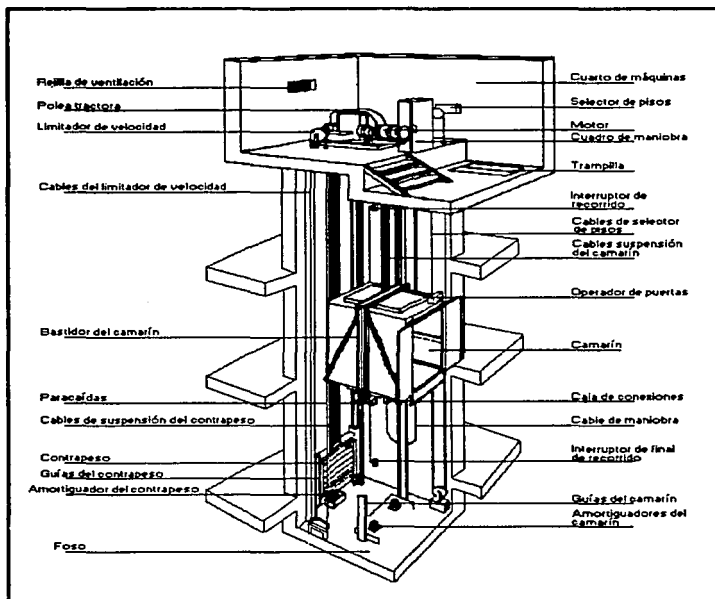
Conjunto de los elementos que componen un elevador de puertas automáticas.
